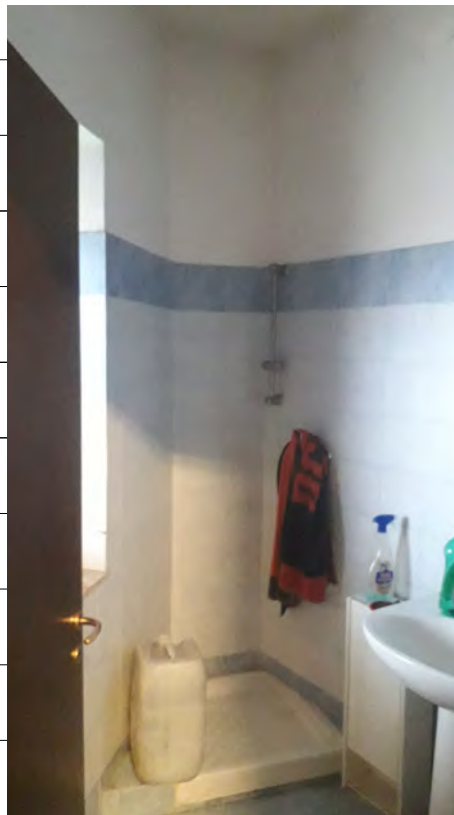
immagine interna del locale adibito a wc ubicato al primo piano dell'edificio.
